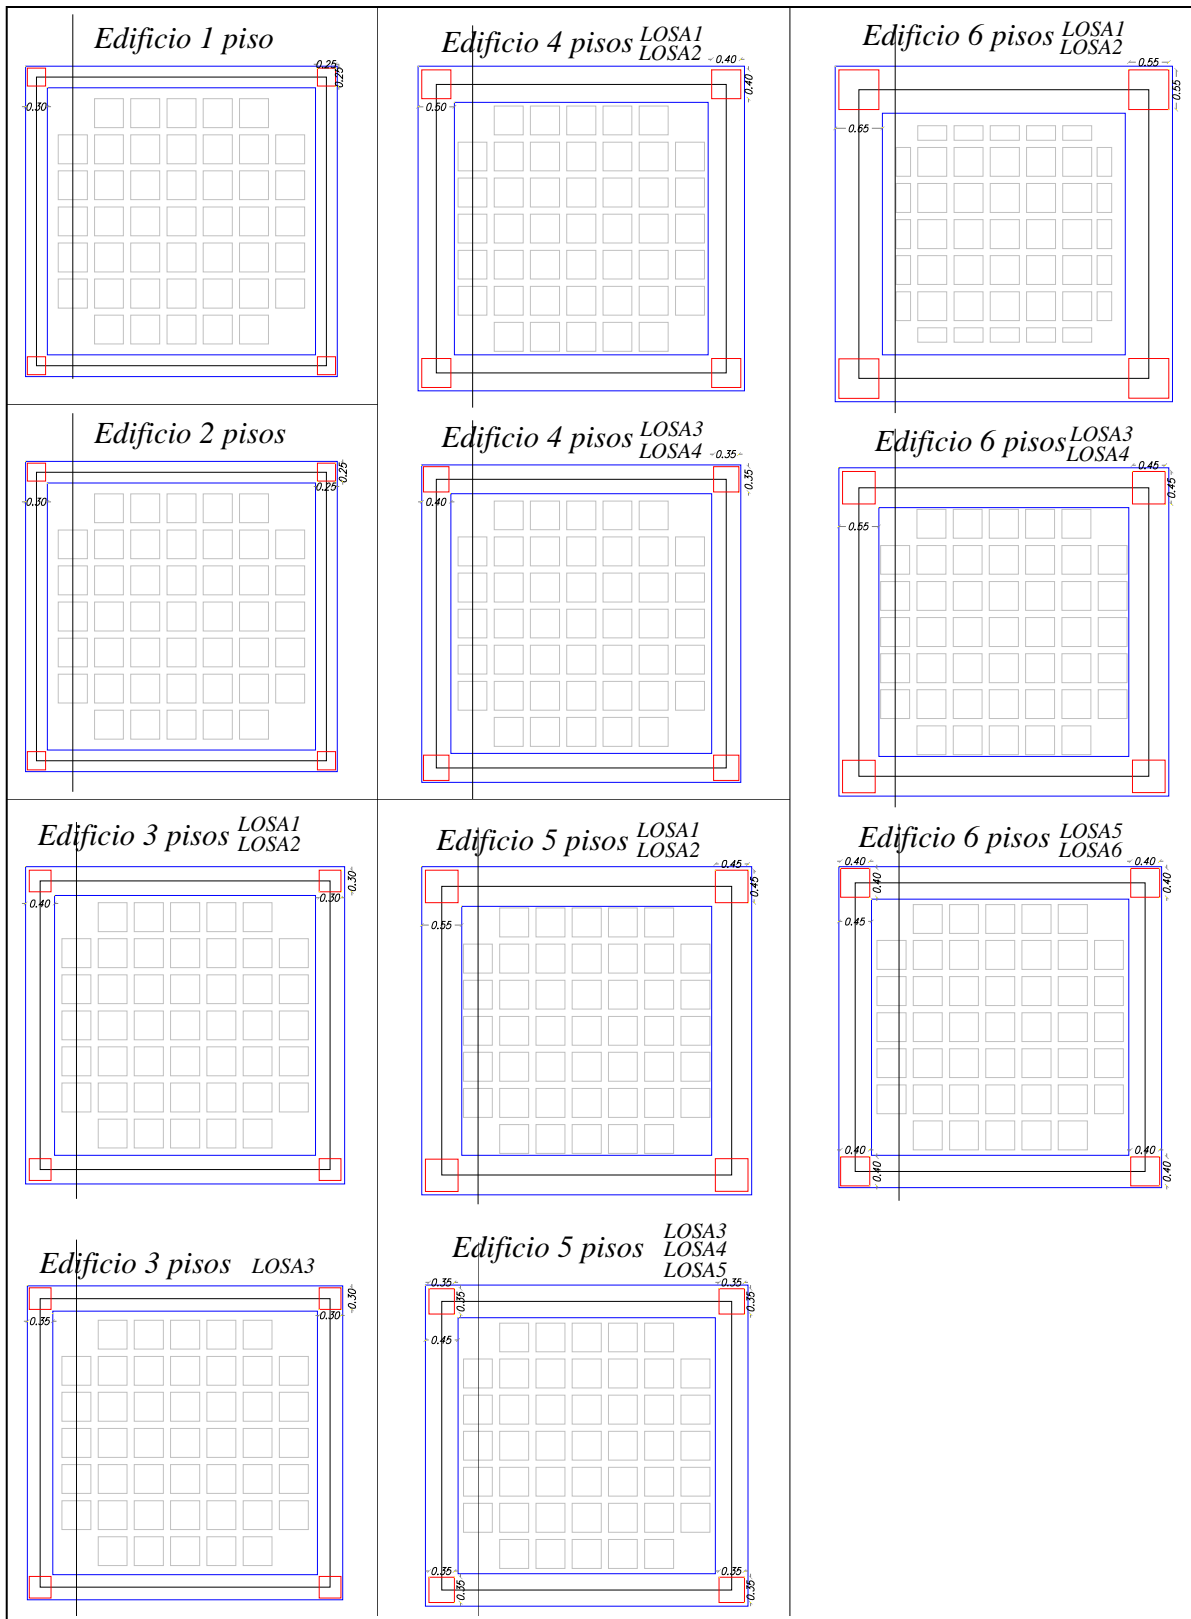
Distribución de bloques en vanos de plantas tipo de las estructuras de análisis
